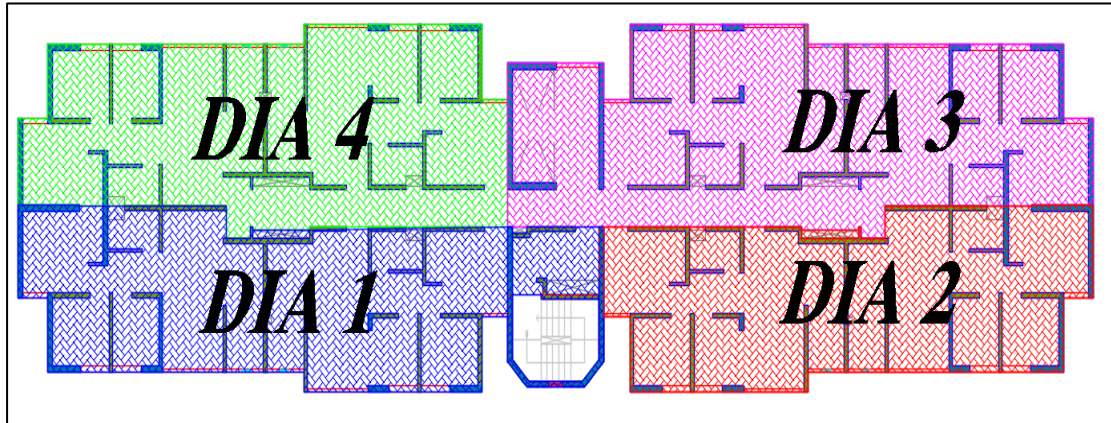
Sectorización Final de proyecto 02 – Tipo Techo Propio. Fuente: Proyecto 02 - Requerimiento
